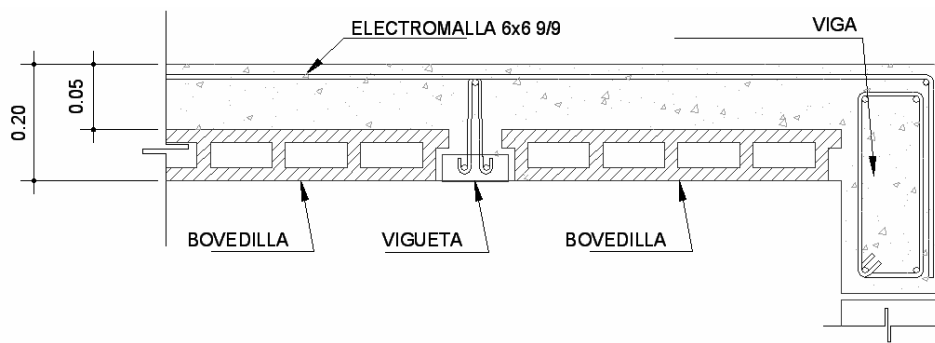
Especificaciones del sistema de losa prefabricada nivel 1
